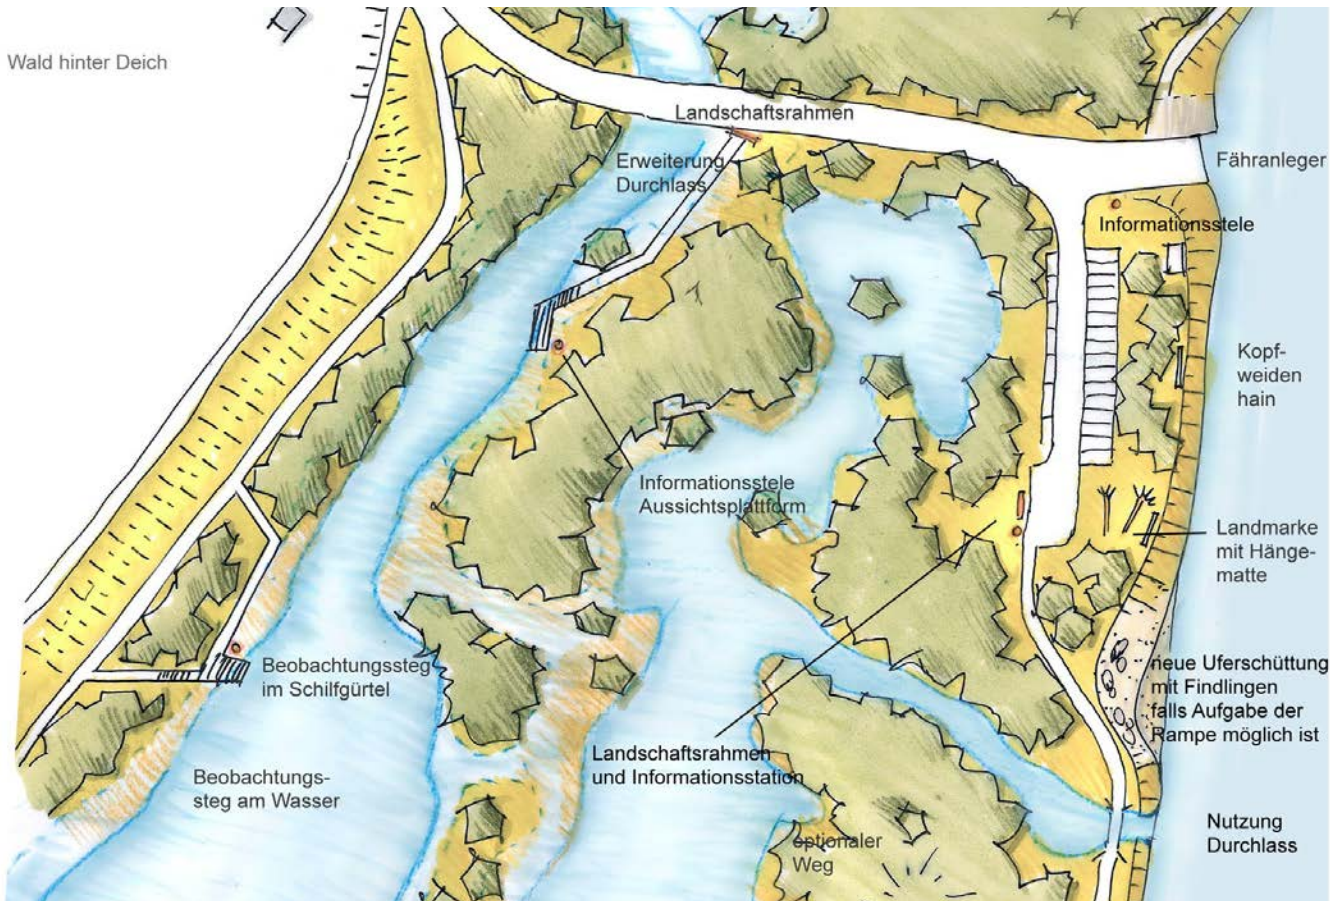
Lageplan Umgestaltung Fähranleger, M 1:1.000
